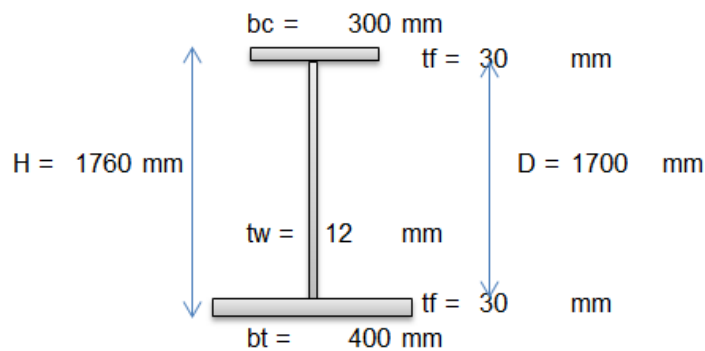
5: Dimensiones adoptadas de la viga metálica
